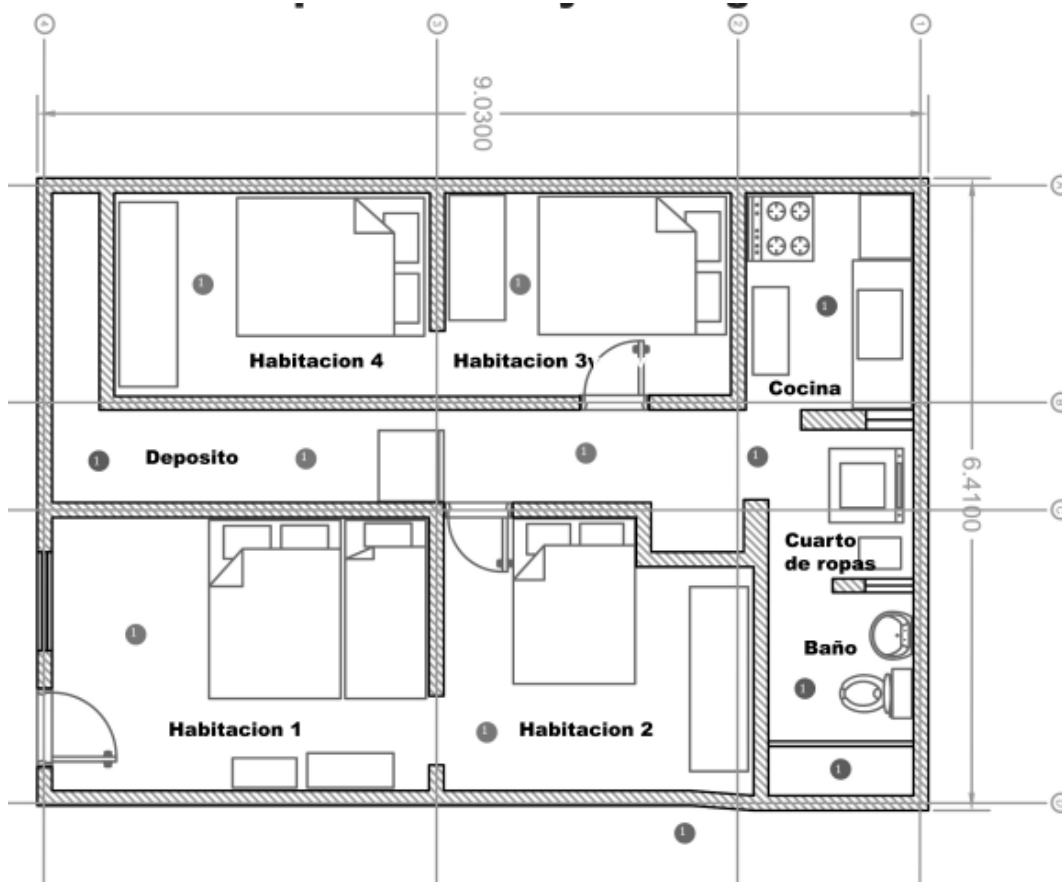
Proyecto vivienda popular, planta arquitectónica. Levantamiento 2015.
